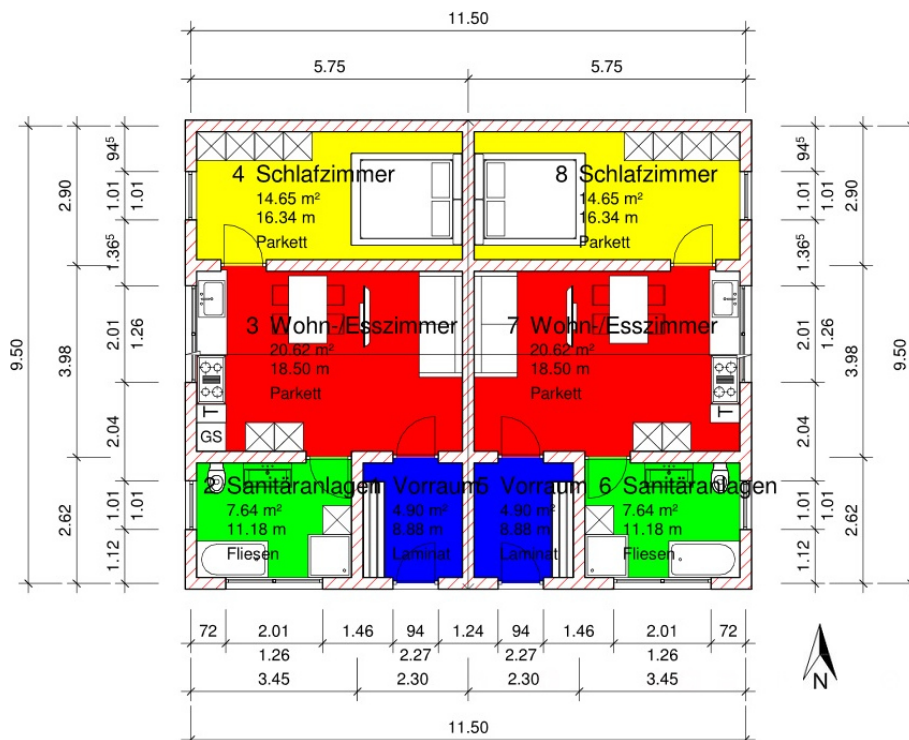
Neubau Bungalow - Grundriss Bungalow
